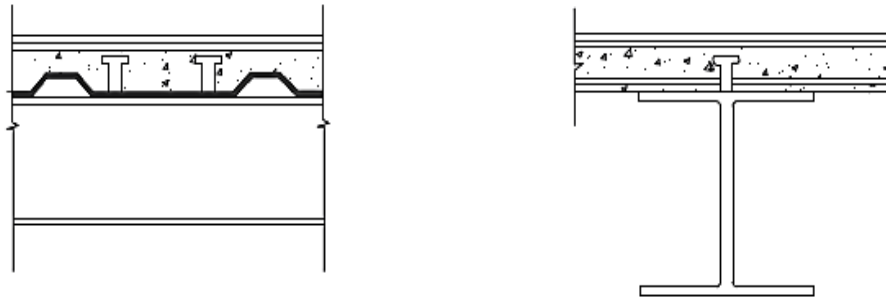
Vigas de acero que soportan una losa de concreto reforzado.
